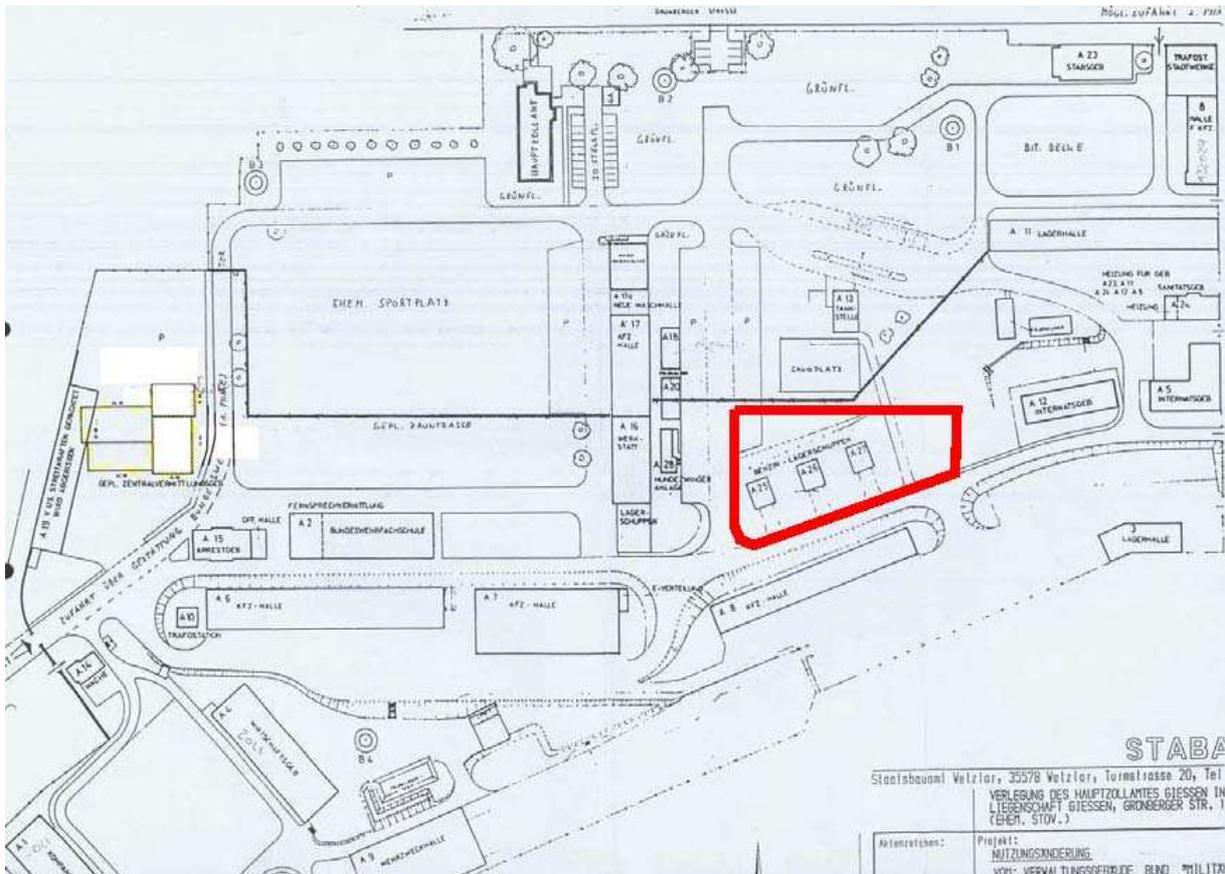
Bestandslageplan mit Gebäudenummern, Quelle: Hessisches Baumanagement
